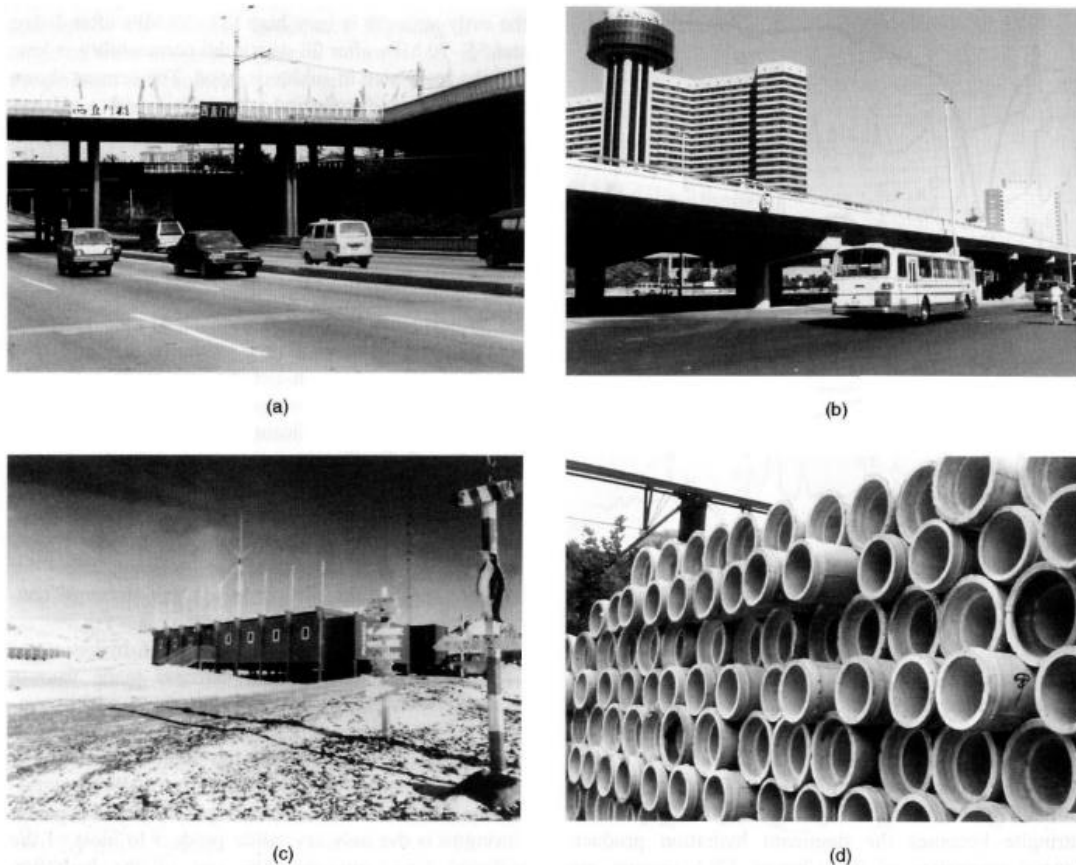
Utilisation du ciment CSA en Chine : (a) pont routier de Xizhimen, Pékin; (b) poutre en béton préfabriqué fabriquée à partir de ciment CSA sans cure thermique, pont routier de Yan Sha, Pékin ; (c) station antarctique chinoise ; (d) tuyaux en béton fabriqués à partir de ciment CSA [14].
